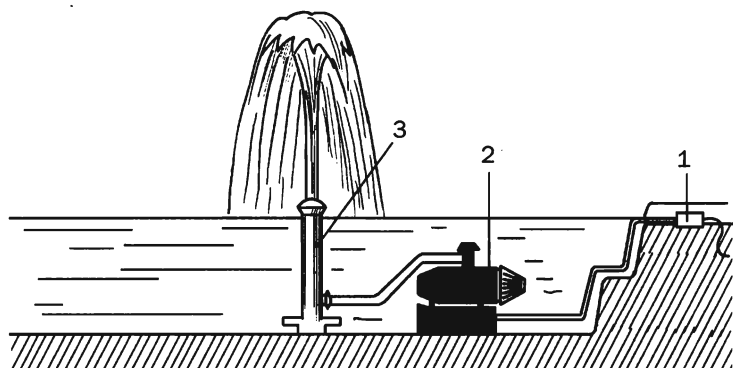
Устройство фонтана: 1 — водонепроницаемый соединитель; 2 — погружной насос; 3 — труба с форсункой
